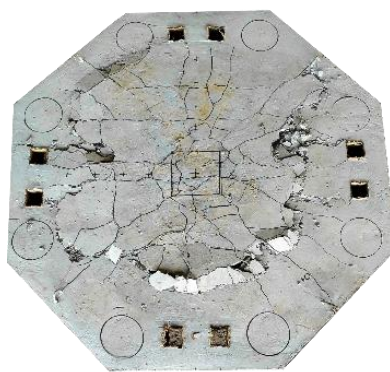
Mapa de fissuração das lajes com $\rho = 1,2\%$.
